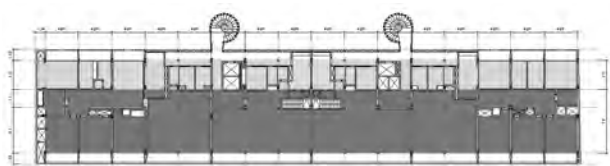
Indicação do pano de laje plana (cinza escuro) e da laje convencional (cinza claro).
